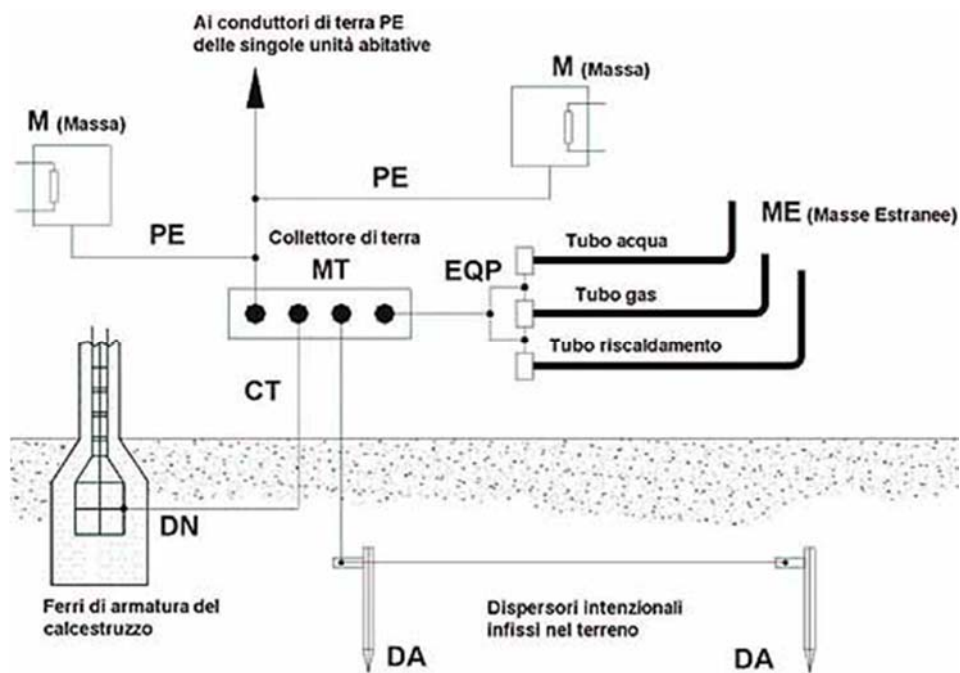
Schema tipico di interconnessione masse e masse estranee all'impianto di terra
